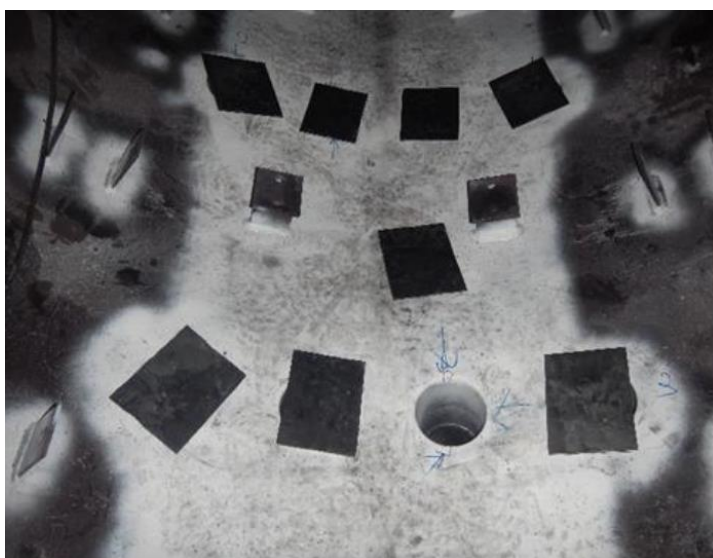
Wskazania na rurach opadowych w drugim rzędzie, carga 4.
